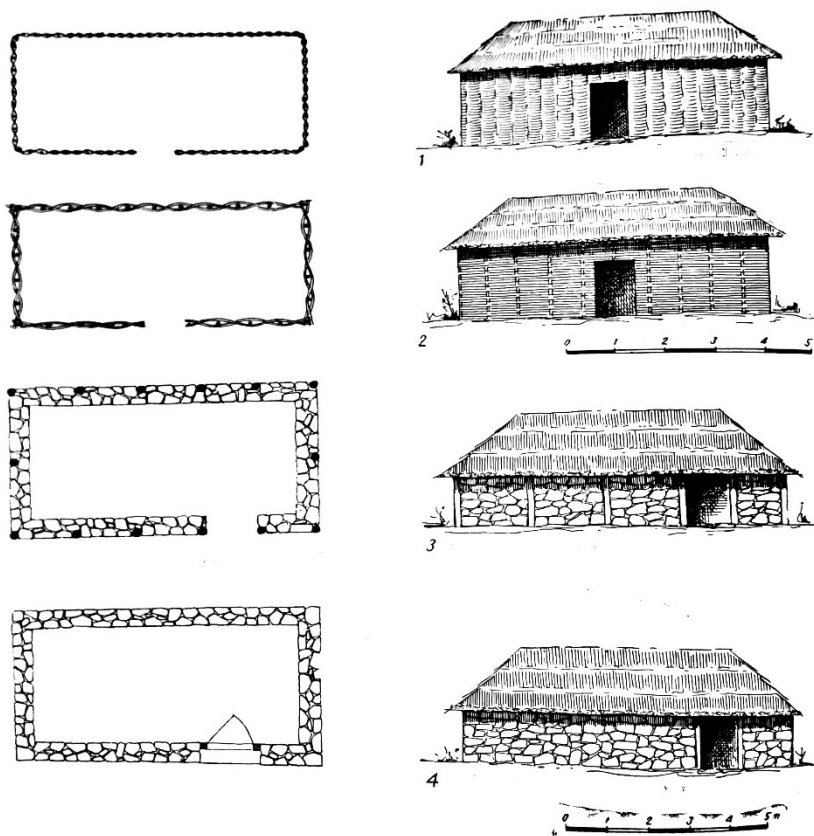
rechteckige Kasollen mit 4 verschiedenen Wänden (Grundriss und Skizze) (Zheku, 1973)
